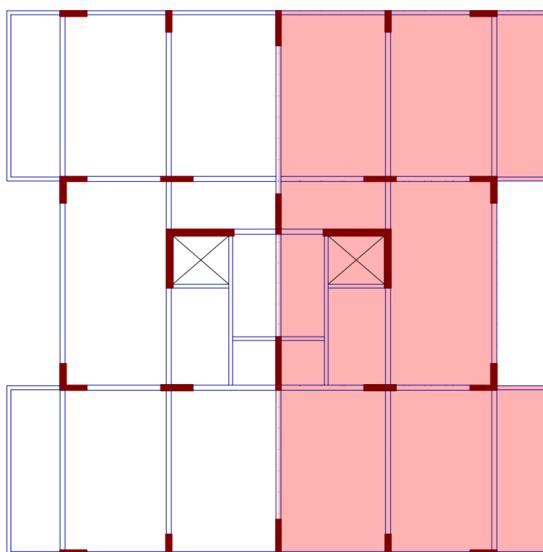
Planta simétrica, área hachurada em detalhe abaixo
